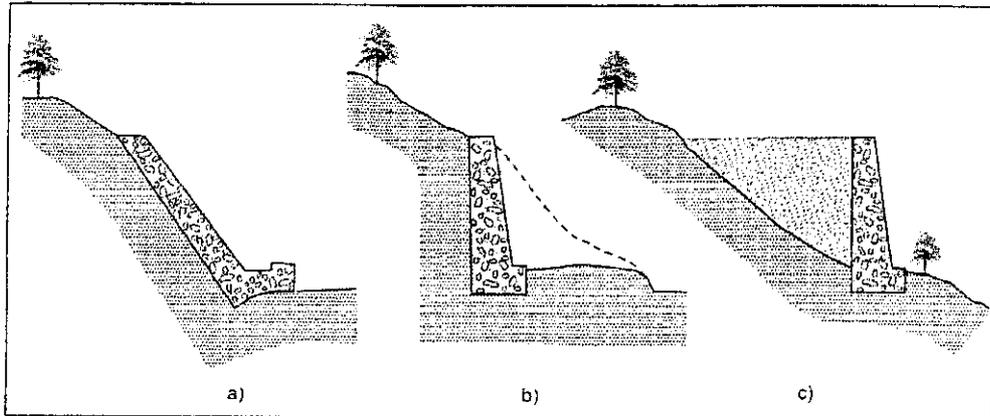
Tipo de muros: a) muro de revestimiento, b) muro de contención, c) muro de sostenimiento.
